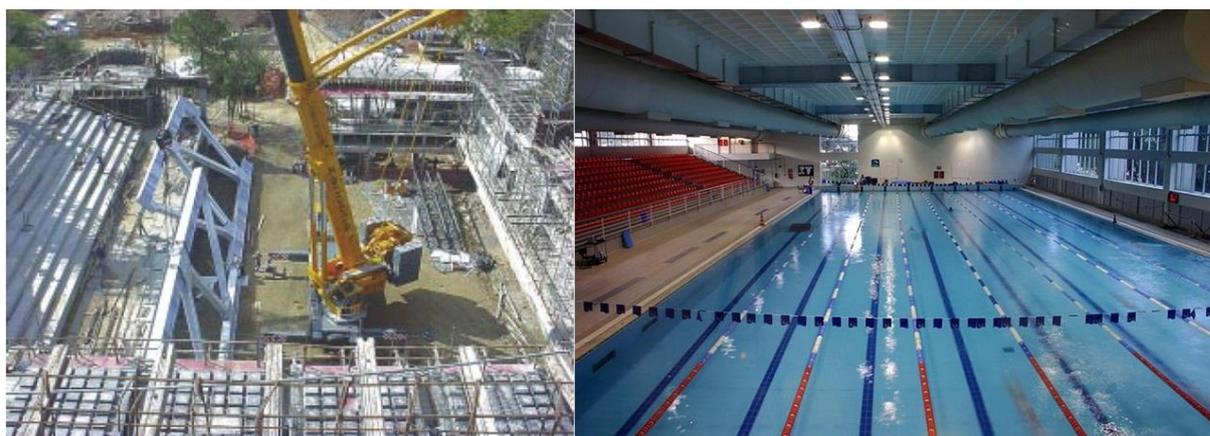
Vigas 8 metros em etapa de obra - Pavimento das quadras polivalentes concluídas
